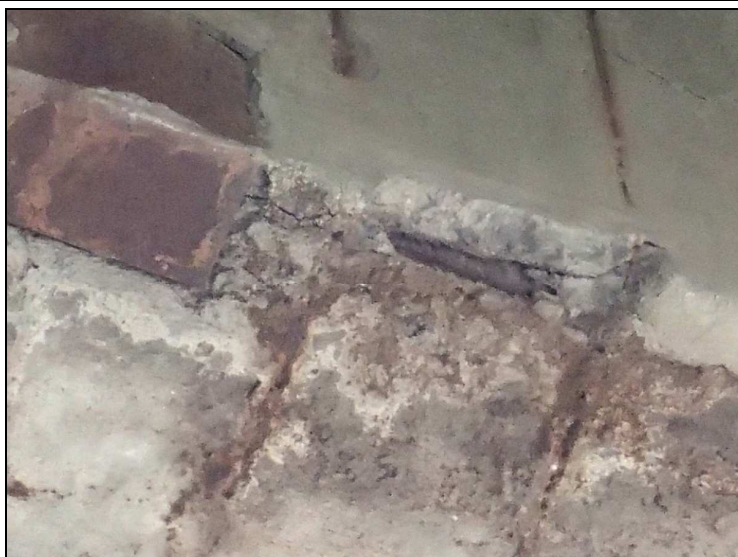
konstrukce K 01 – nad O 02 – 4. nosník zleva – obnažená předpínací výztuž, koroze, průsak vody a pojiva
